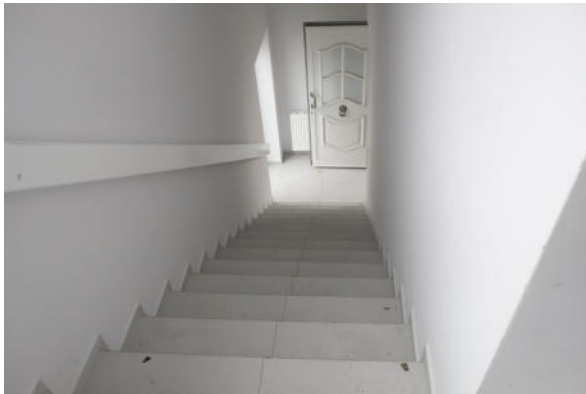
Treppe zwischen dem Erd- und Dachgeschoss
